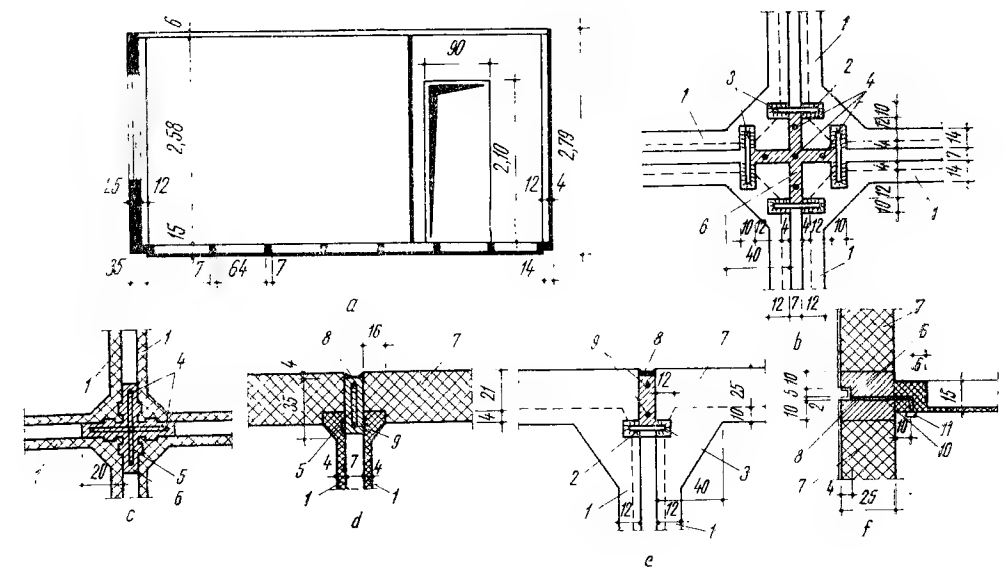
Structură de rezistență din elemente spațiale pentru clădiri de locuit :
